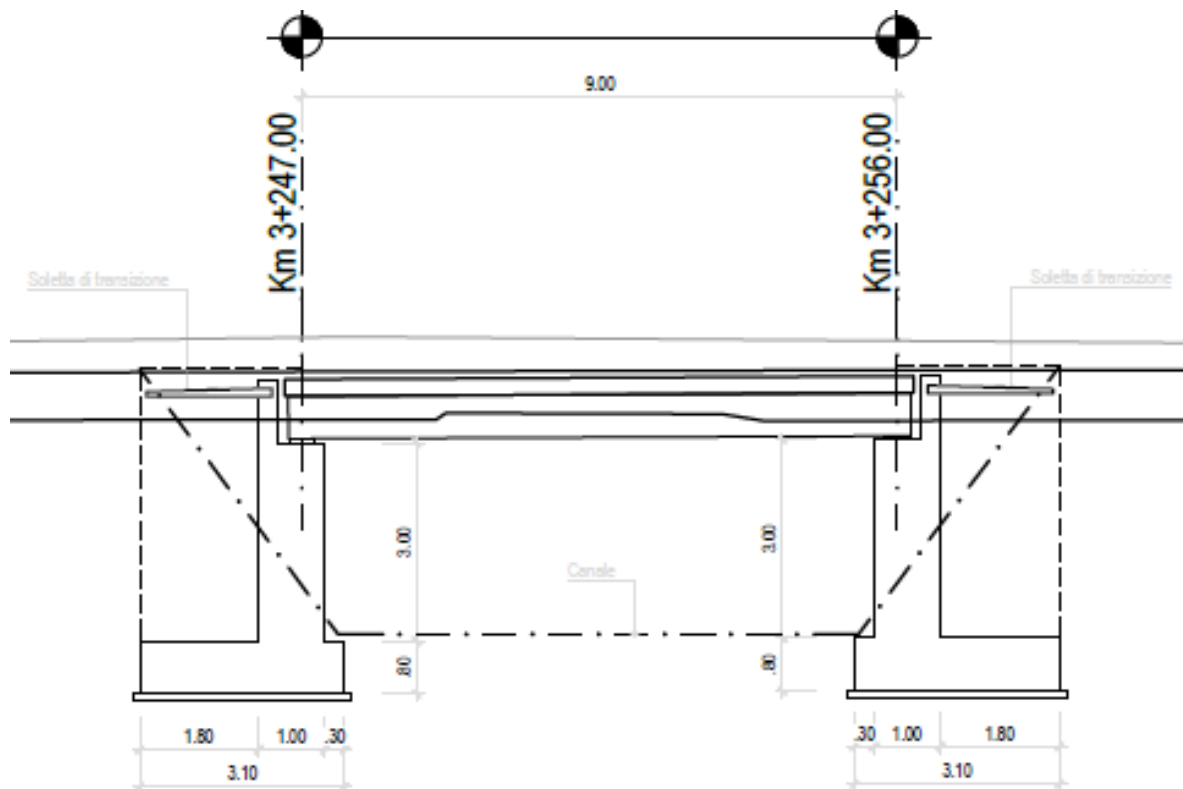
Planimetria, profilo e sezione Ponticello PO02
